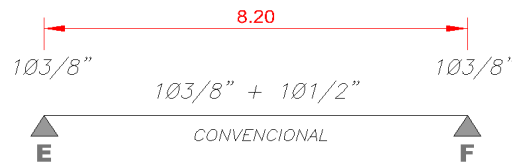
Esquema de las Viguetas Convencionales con su Acero de Refuerzo, en el Paño “P”.
